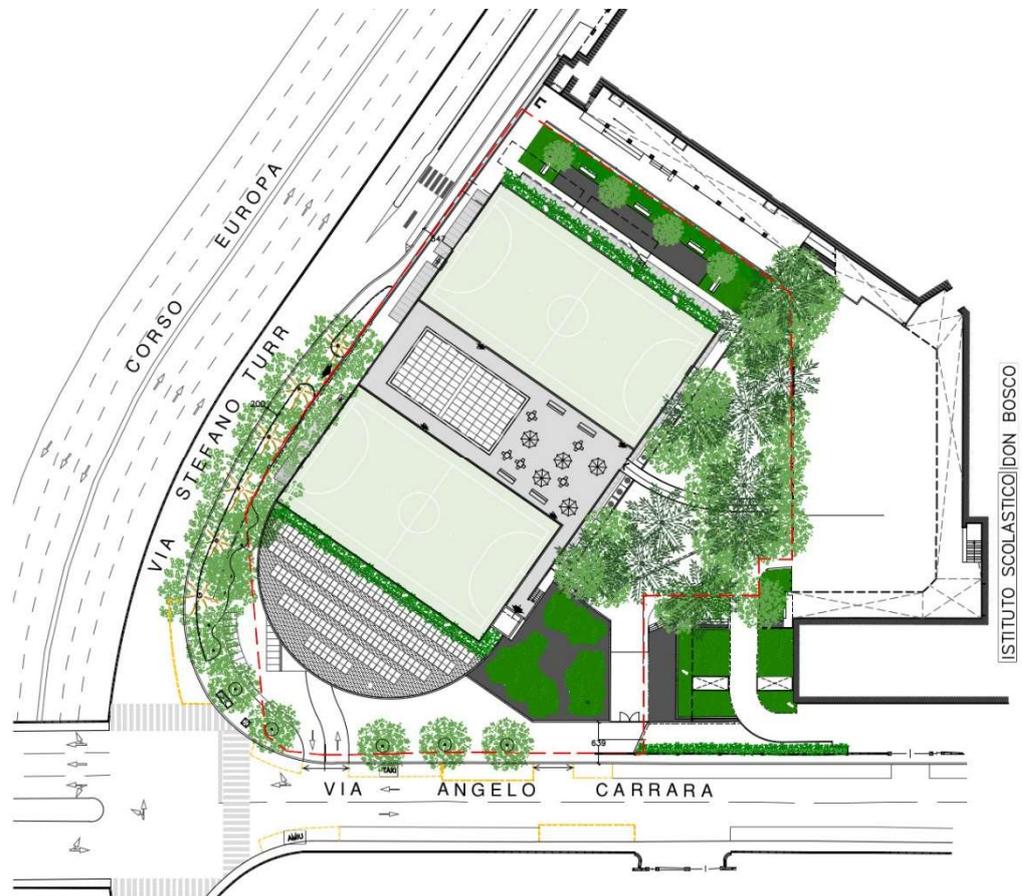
Planimetria generale di progetto, delimitata in rosso l'area di intervento.
